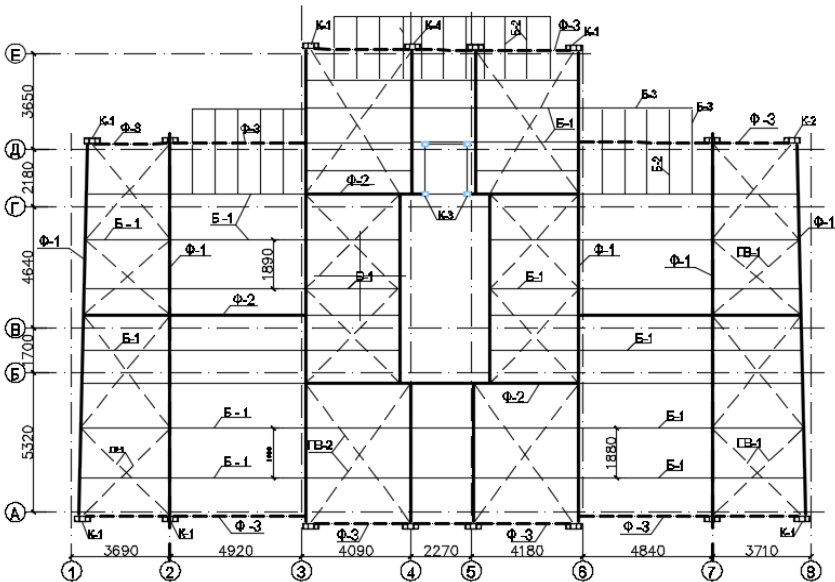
План розташування металевих ферм та балок над горизонтним перекриттям.
